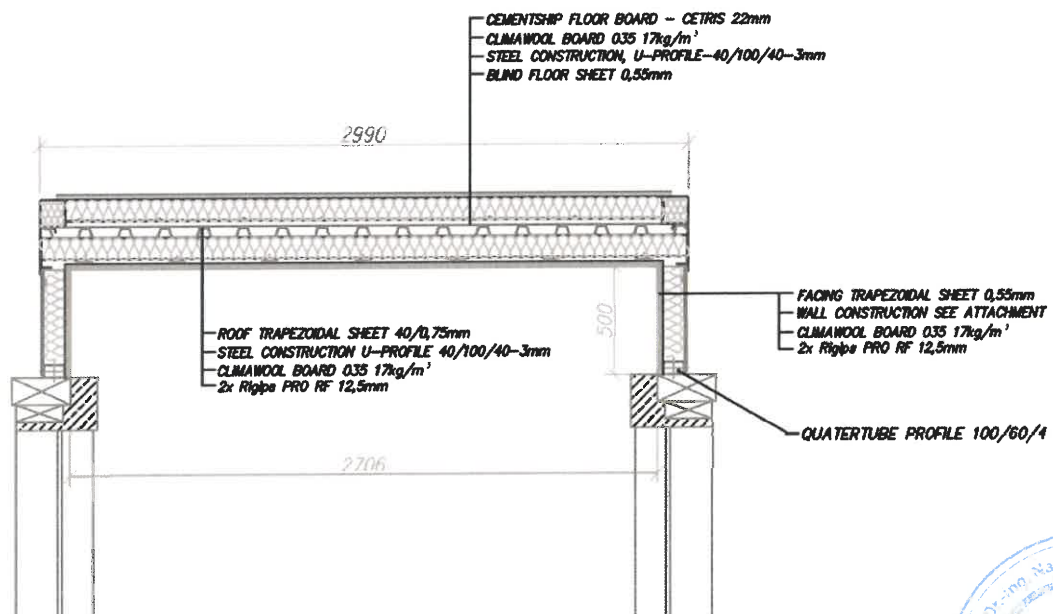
Querschnitt des Aufbaus der Containerkonstruktion (Geschossdecke) (3)
